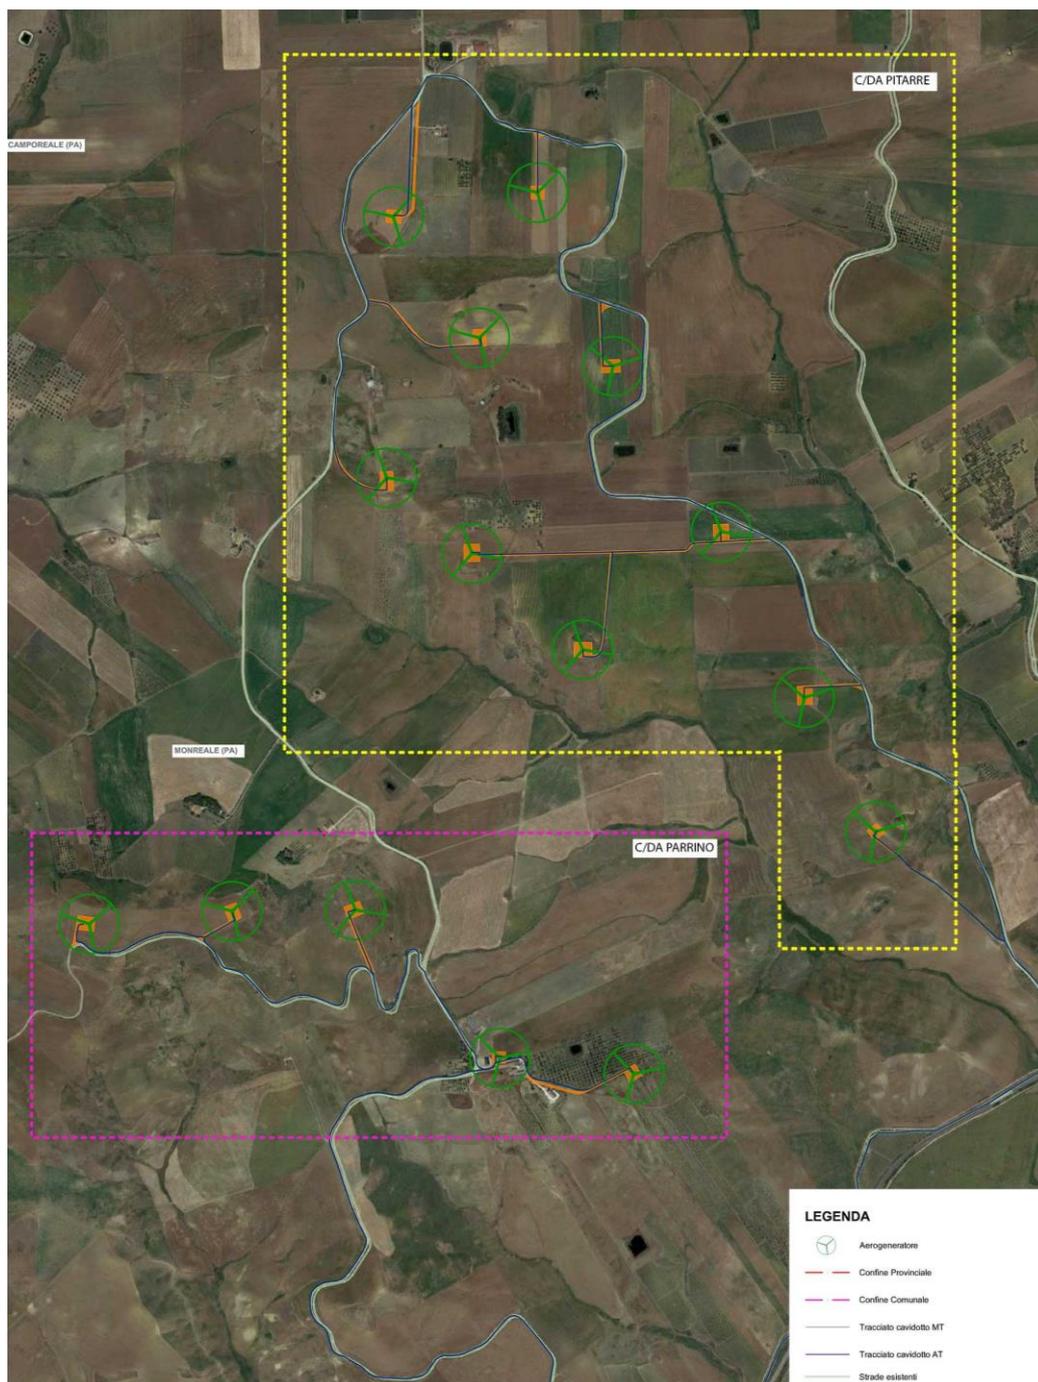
C - Ortofoto dell'area di impianto ricadente sul territorio di Monreale (PA – C/da Parrino e C/da Pitarre) e cavidotto di connessione
